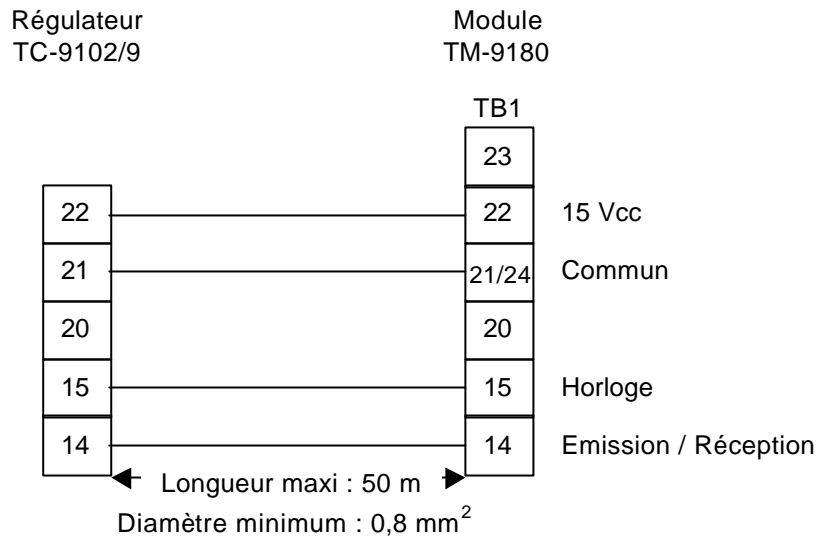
Câblage du module TM-9180 sur un régulateur TC-9102 ou TC-9109
